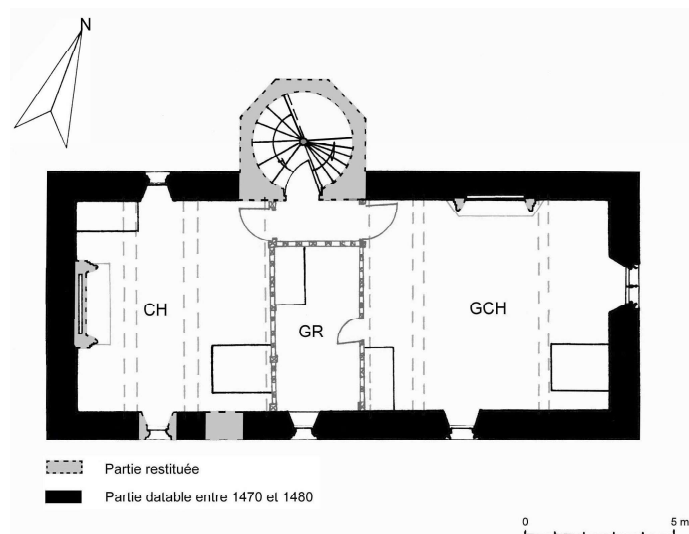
Perriers. Plan restitué du premier étage entre 1470 et 1480.
